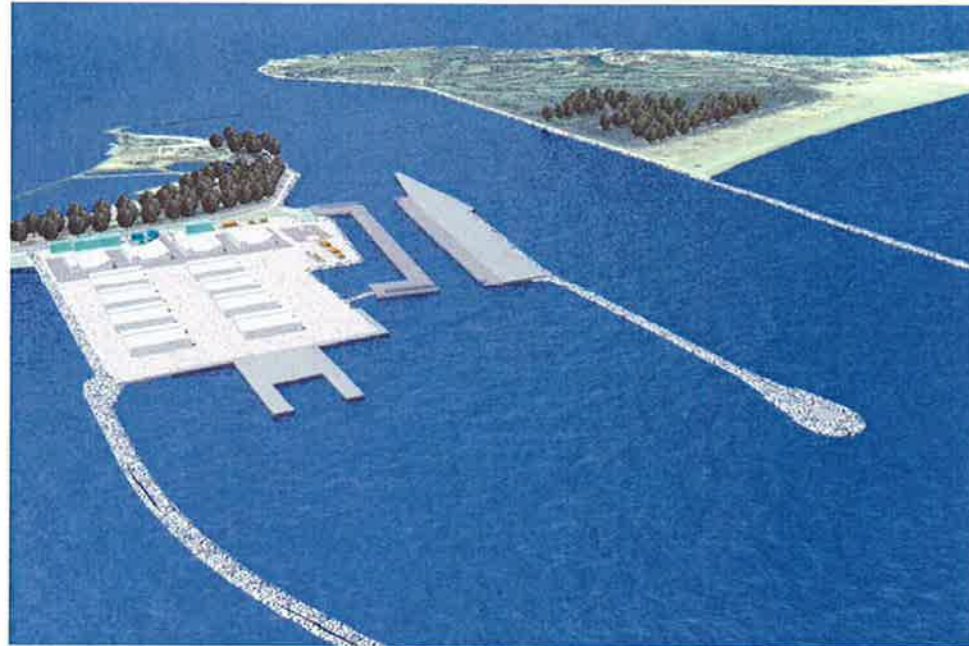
cantiere di Malamocco vista del cantiere da mare lato sud
